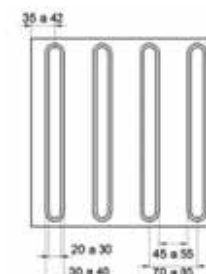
Piso tátil Direcional - Dimensões em milímetros.
